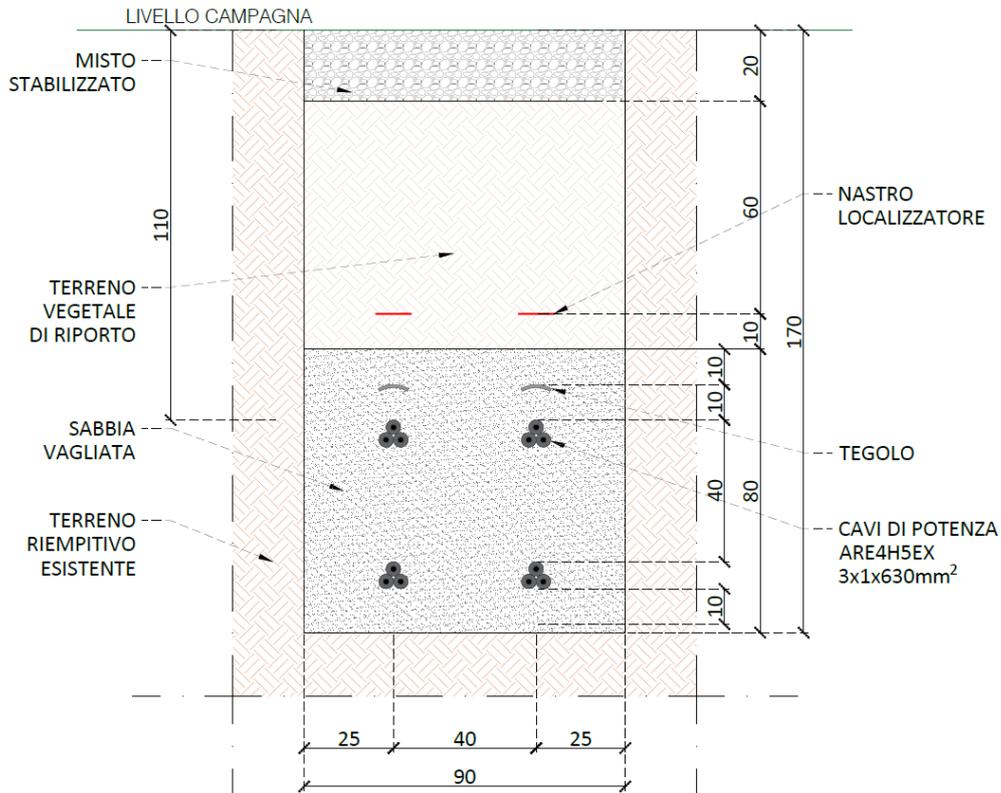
Sezione di scavo cavidotto MT di collegamento tra impianto e stazione di trasformazione 150/30 kV
